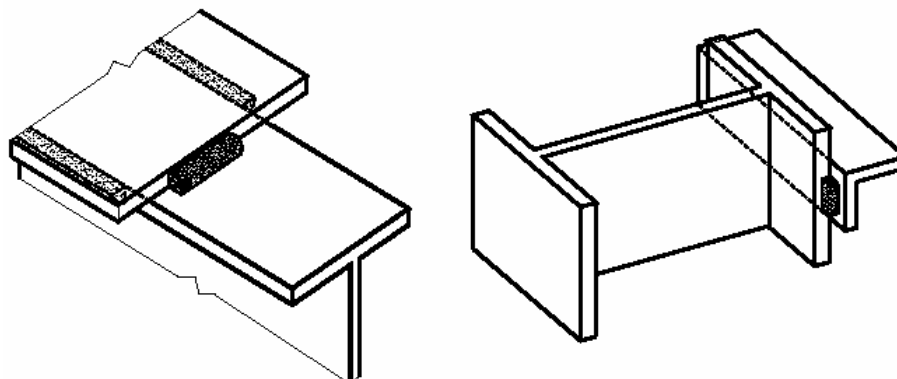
Tipo de electrodo de soldadura elegida.
